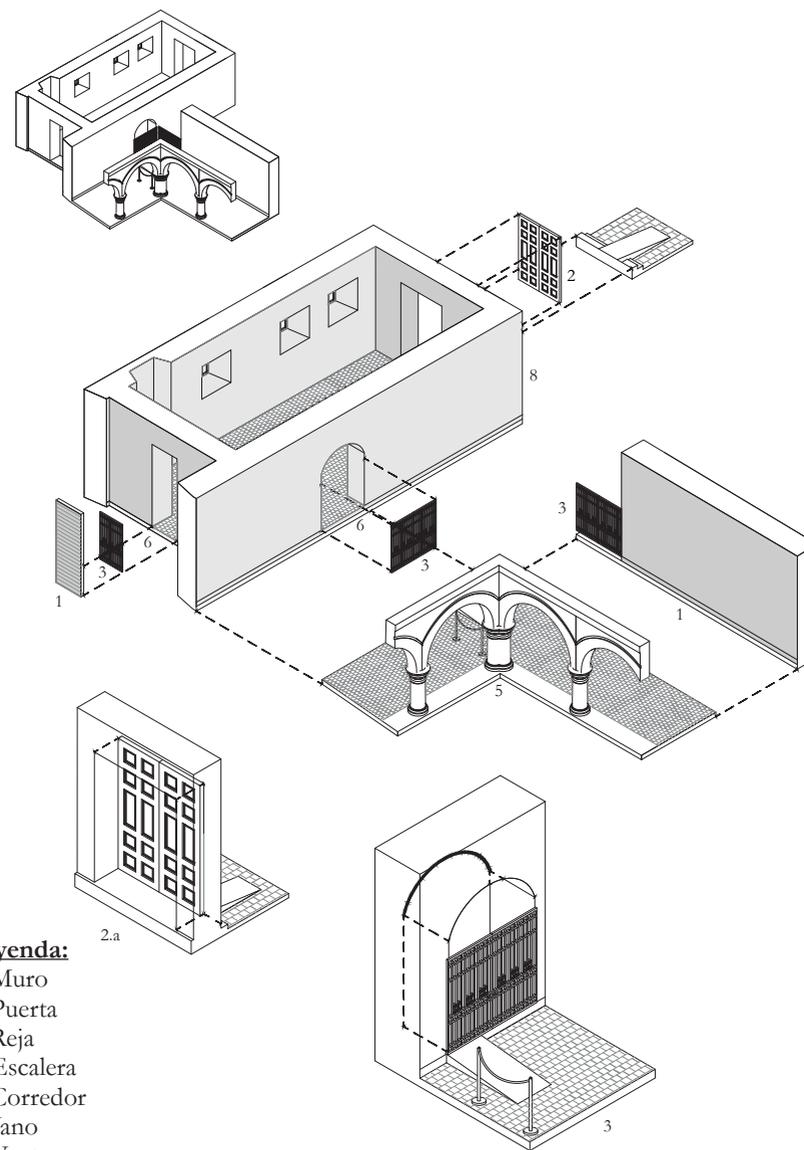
Plano ubicación mediador Traspaso entre Exteriores Divergentes. (2020). Planimetría. Elaboración propia.
